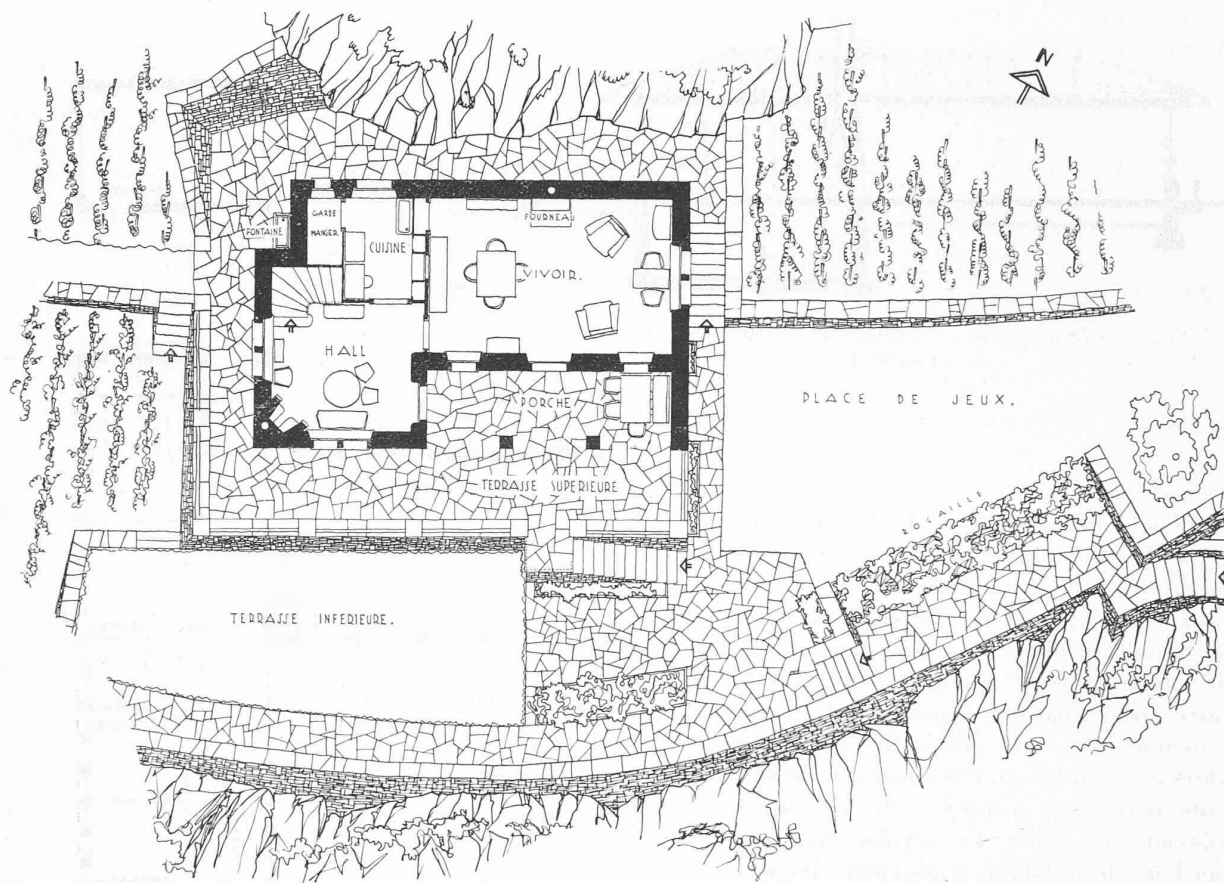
Vouga : Plan du rez-de-chaussée. Echelle 1 : 200.
